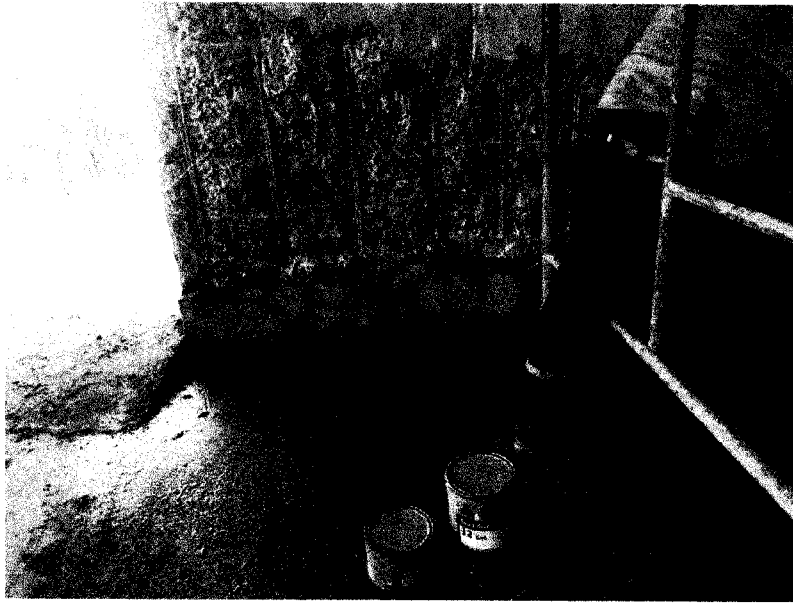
Aplicación de Sikadur 32 para adherencia de concreto nuevo y concreto viejo
